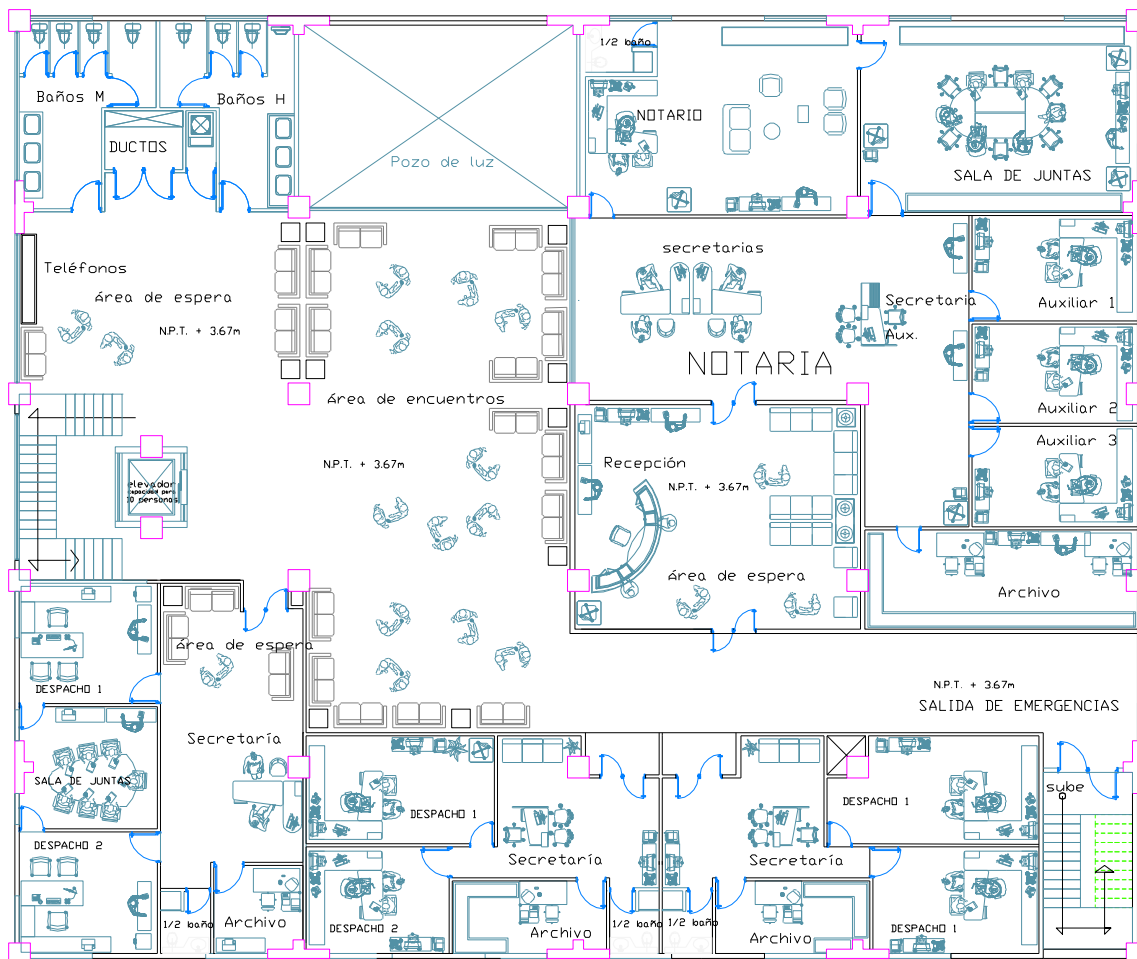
Plano de arquitectura de la planta típica. (Fuente Propia).
